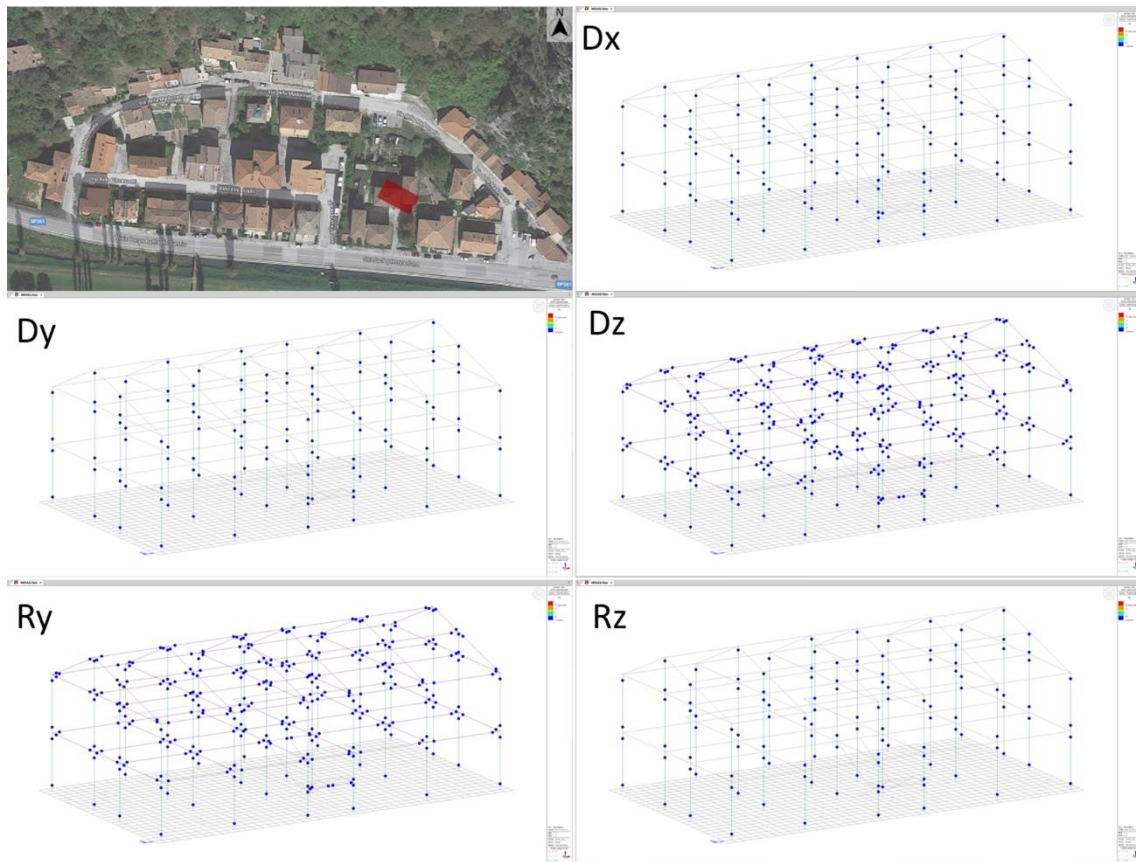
Cedimento fondale applicato ad un edificio in acciaio a due piani con platea di fondazione nella POSIZIONE 1 all'interno del quartiere "Madonnetta" del comune di Pioraco.
